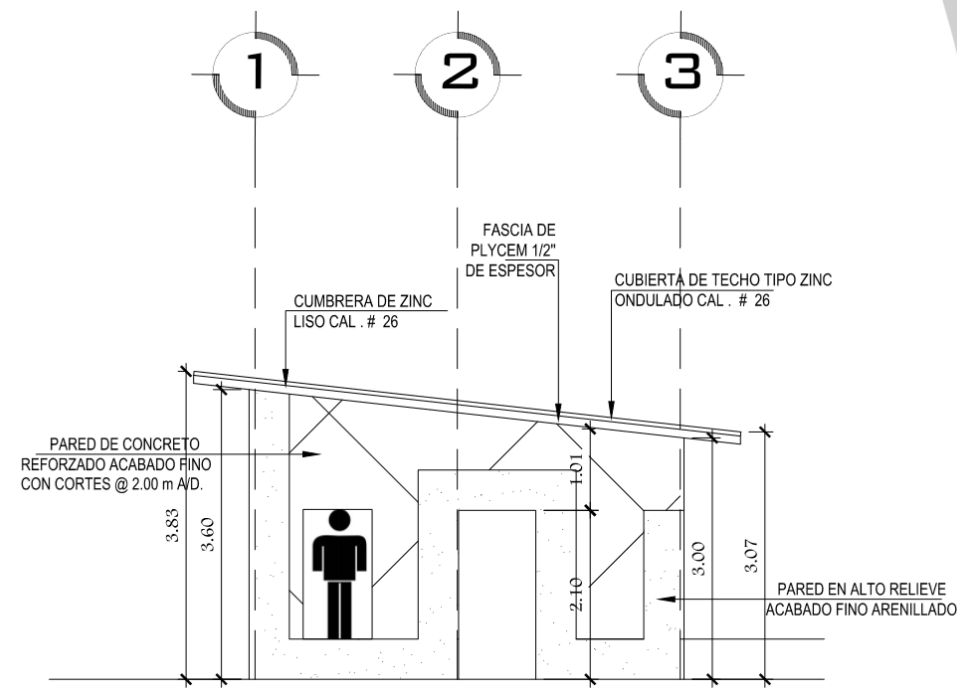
FACHADA S.S CAMPO DE FUTBOL
